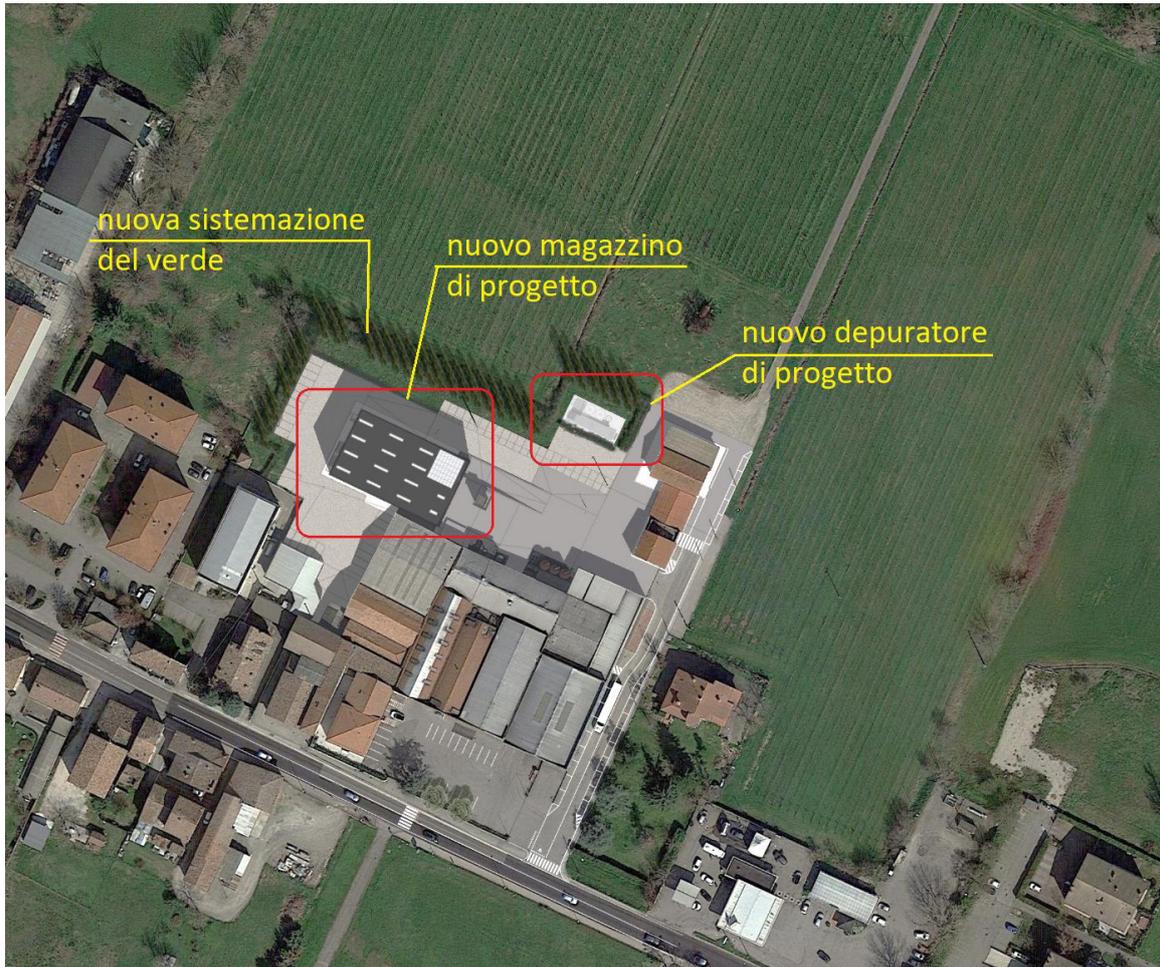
Fotoinserimento dell'ampliamento in progetto
